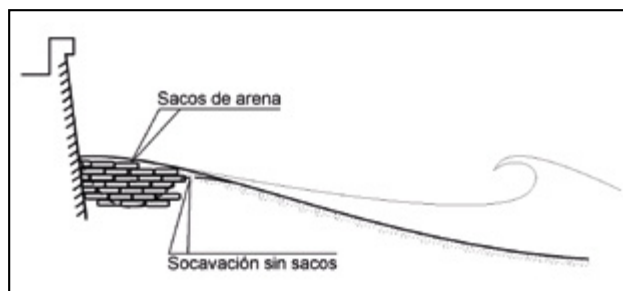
Sacos de geotextil aplicados en la protección contra la socavación.
